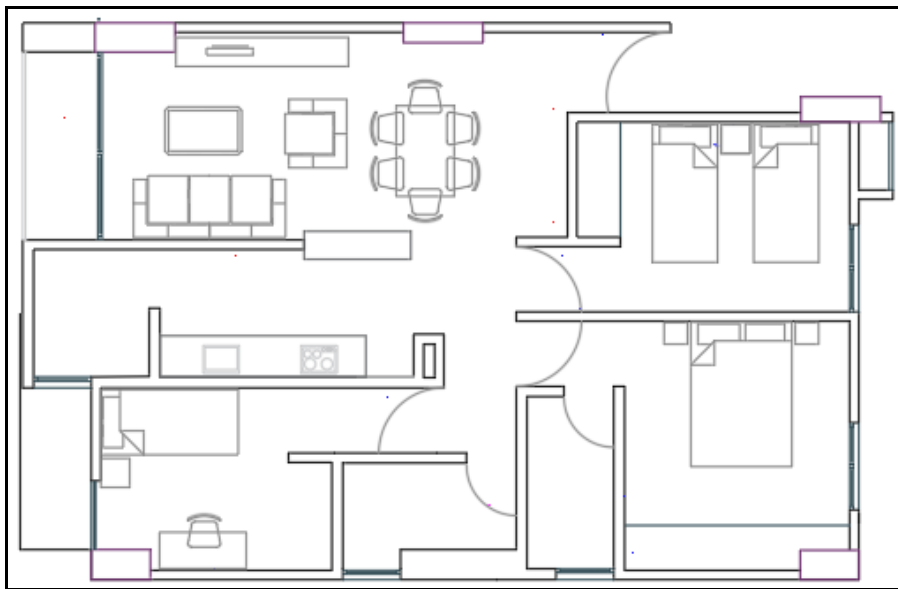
Plano planta del apartamento tipo. Adaptado de: planos arquitectónicos, material académico asignatura instalaciones eléctricas.
